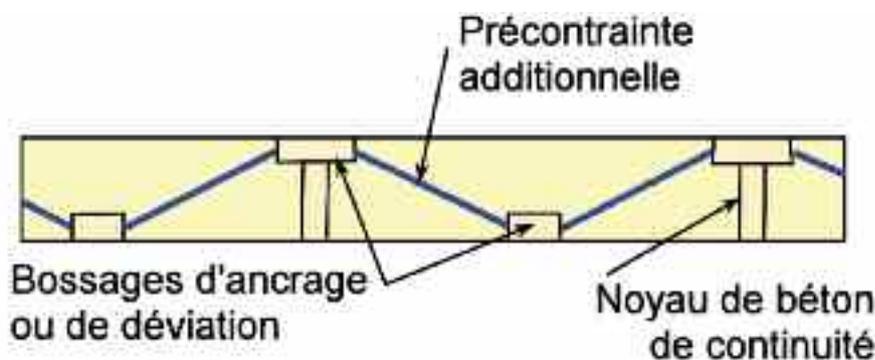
principe du câblage de renfort rendant les travées continues
